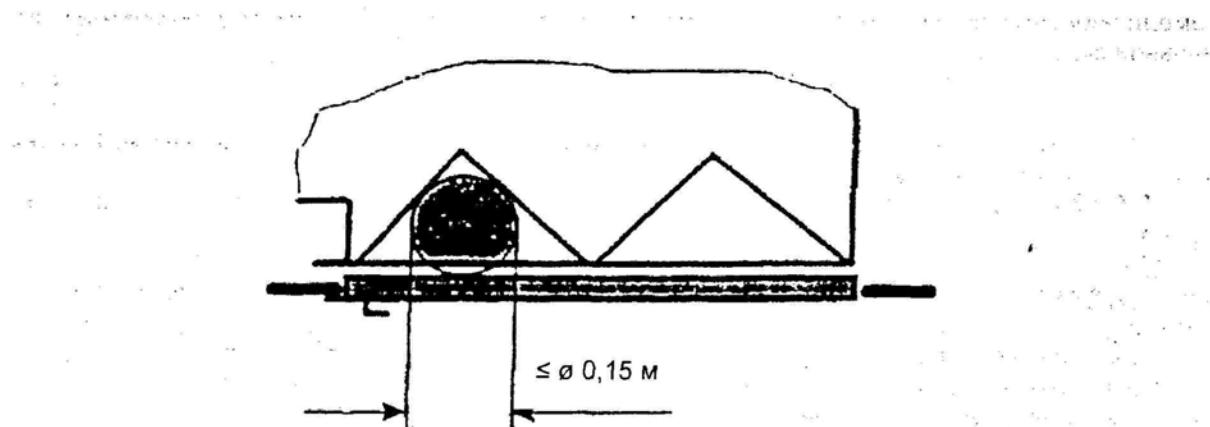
Зазор между распашной дверью шахты и складывающейся дверью кабины
